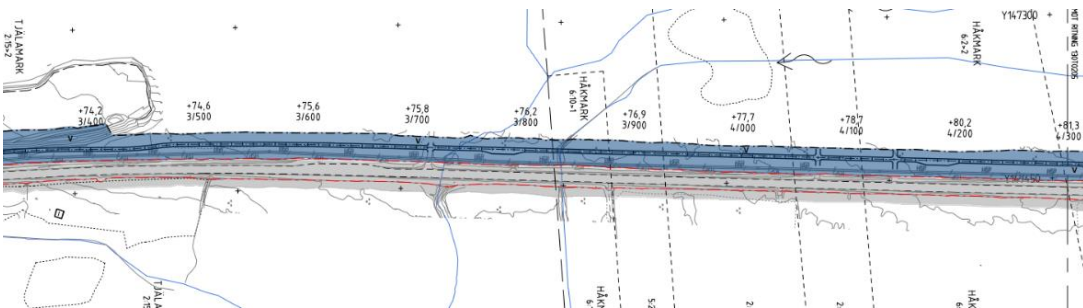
Efter ändring, utsnitt plankarta 130T0202 ca km 1/300 till 2/300.
